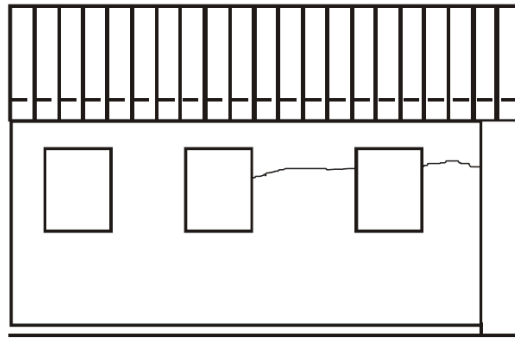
Fissura horizontal na parede por movimentação térmica da laje (DUARTE, 1998)
